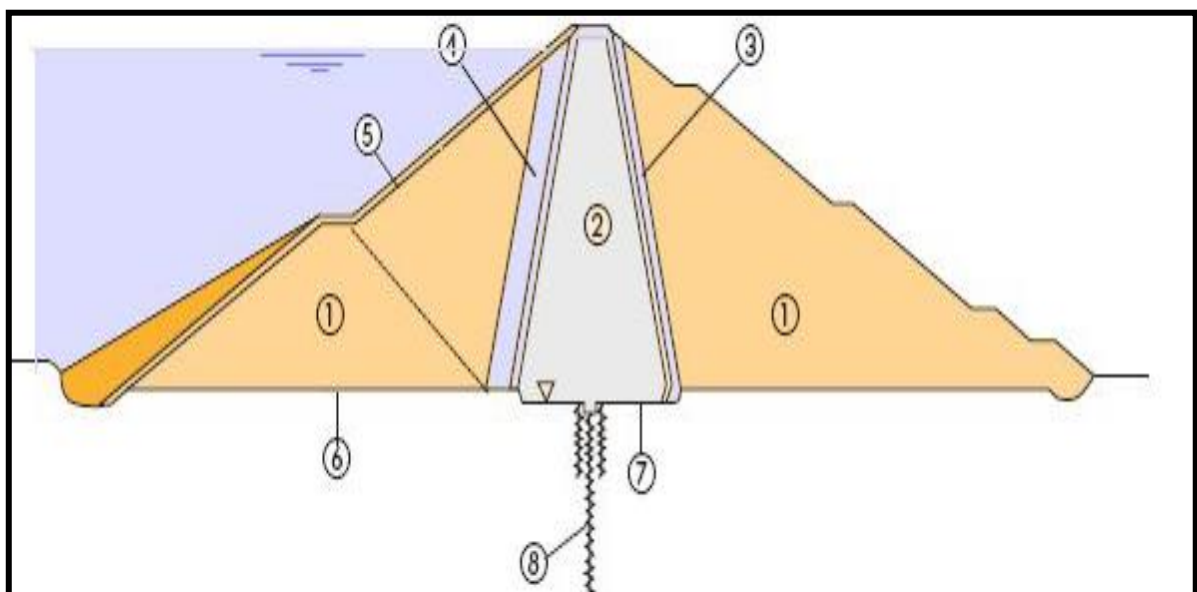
Coupe transversale d'un barrage en enrochementLégende :
